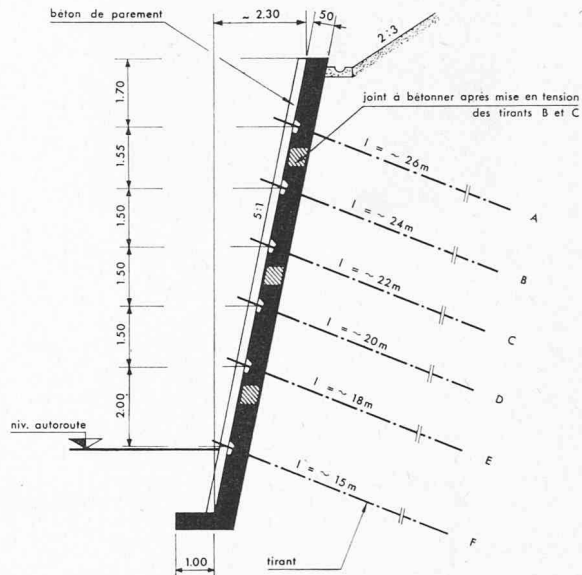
Mur ancré, coupe verticale au droit d'un pilier.
